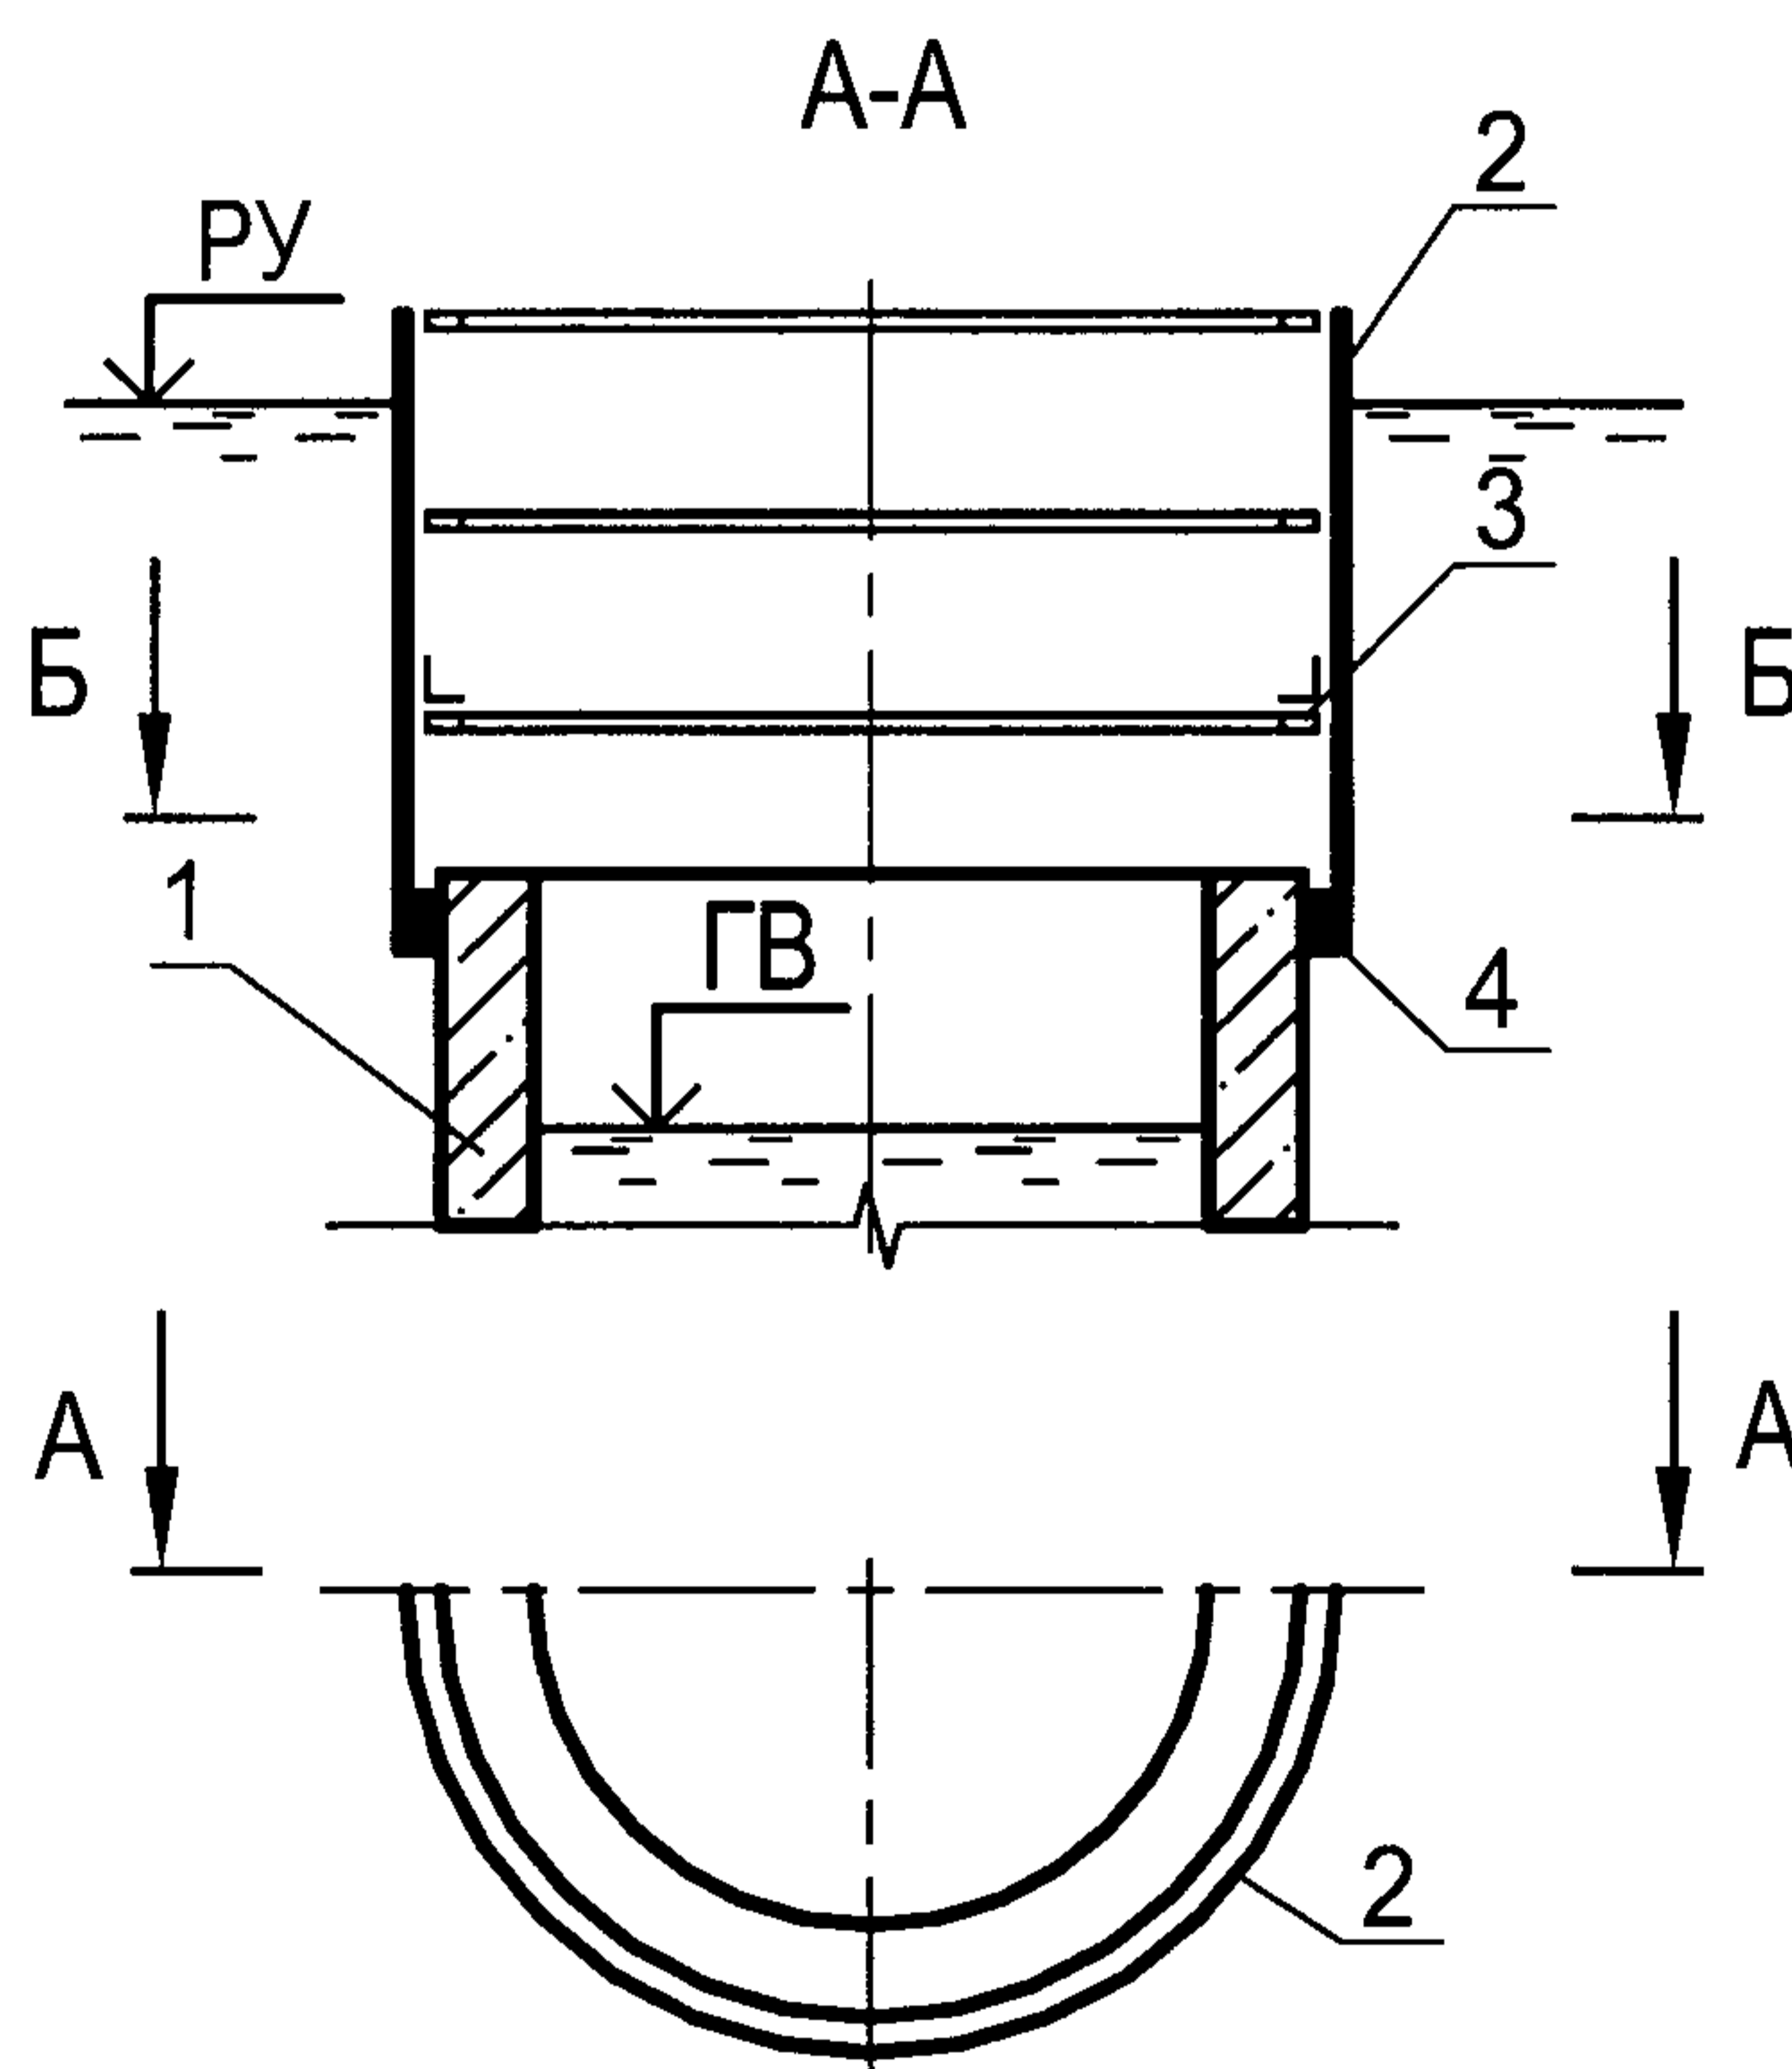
Стальное ограждение верхней части круглого колодца
